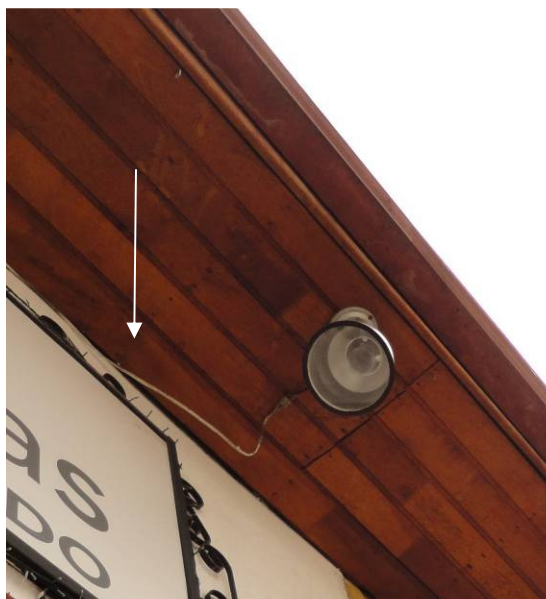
/26/27/28- Vista de fiação interna e externa aparente.
